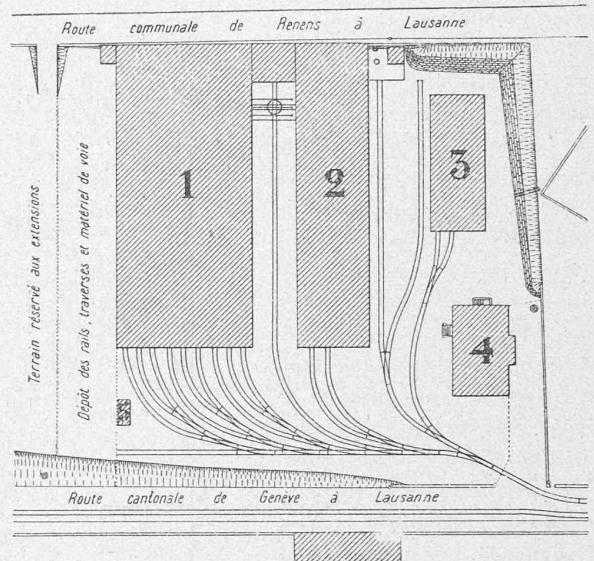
Plan du dépôt des Tramways lausannois, en Prélaz.
